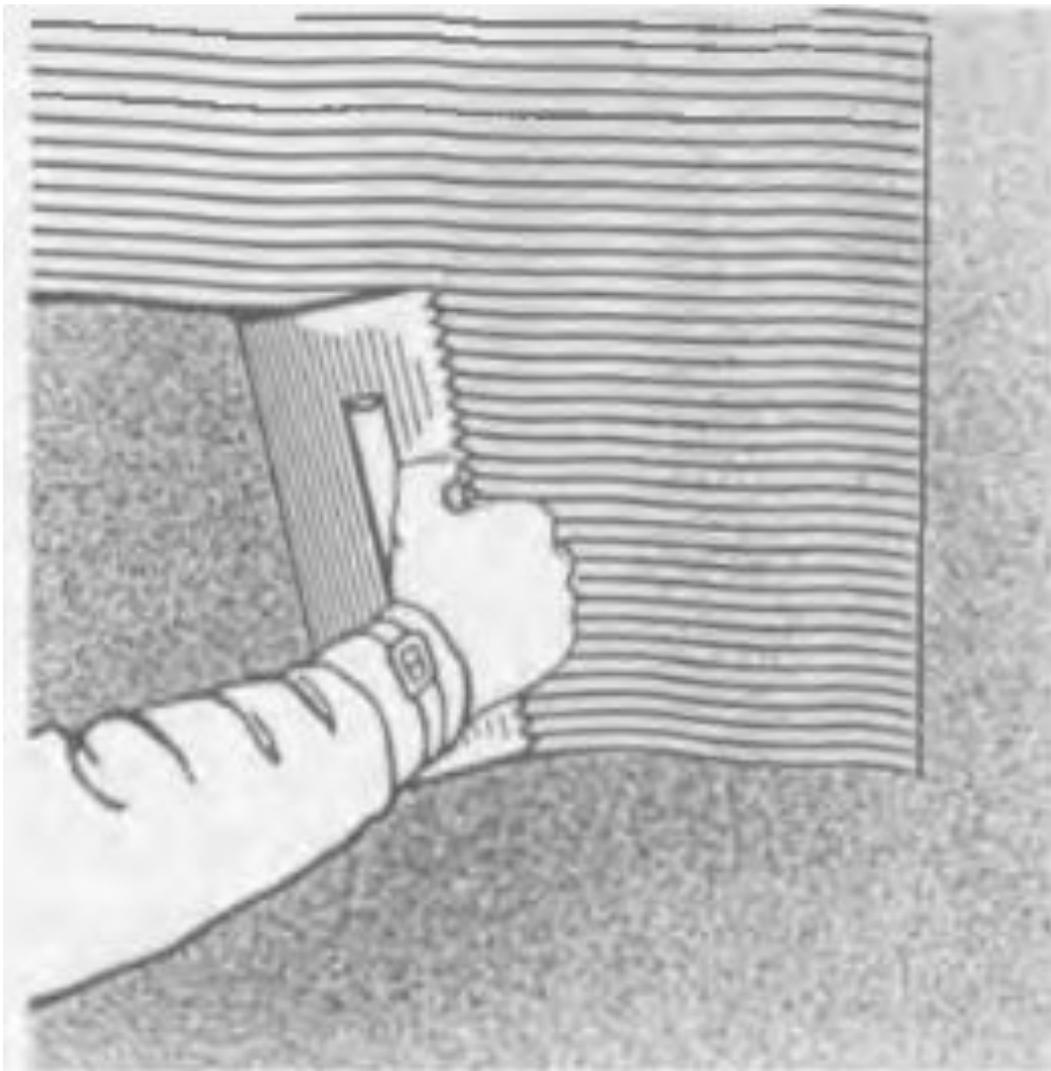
Нанесение клея на поверхность стены зубчатой гладилкой
